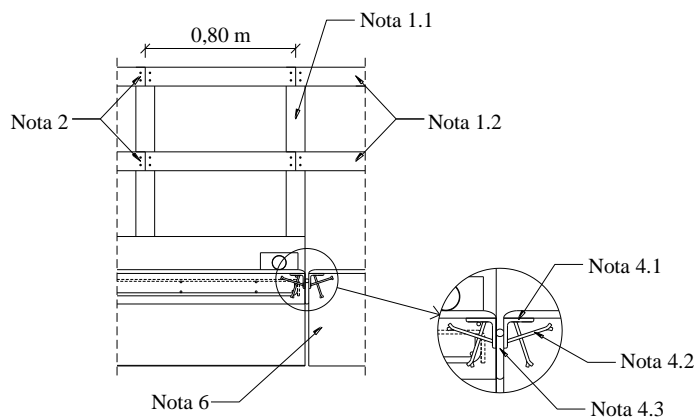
Secção longitudinal dos guarda-corpos e secção transversal das juntas de dilatação (secção AA).
